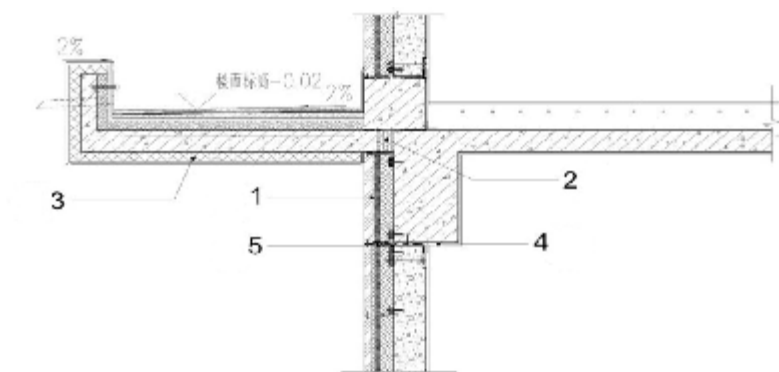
蒸压加气混凝土外墙板悬挑构件构造示意图
